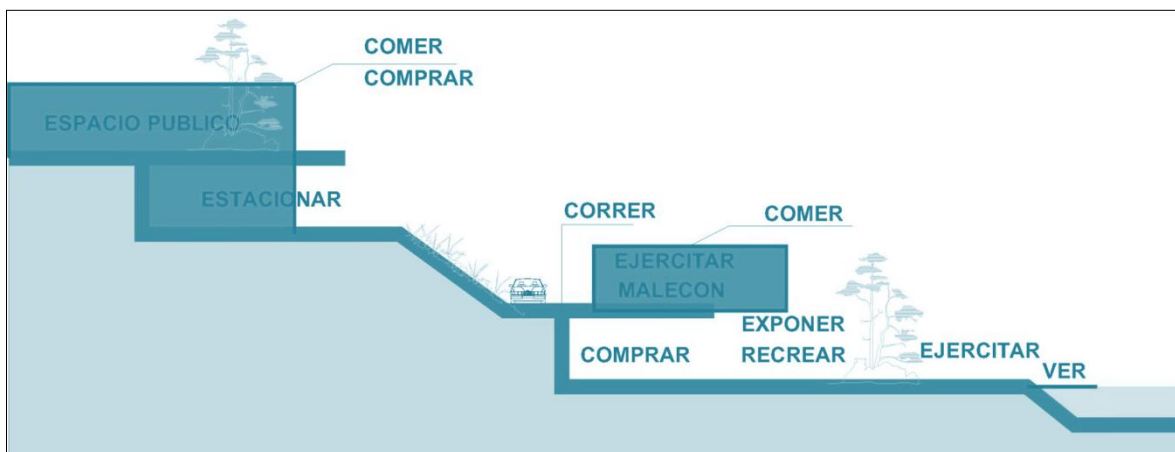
Propuesta Arquitectónica de Volúmenes – Corte
